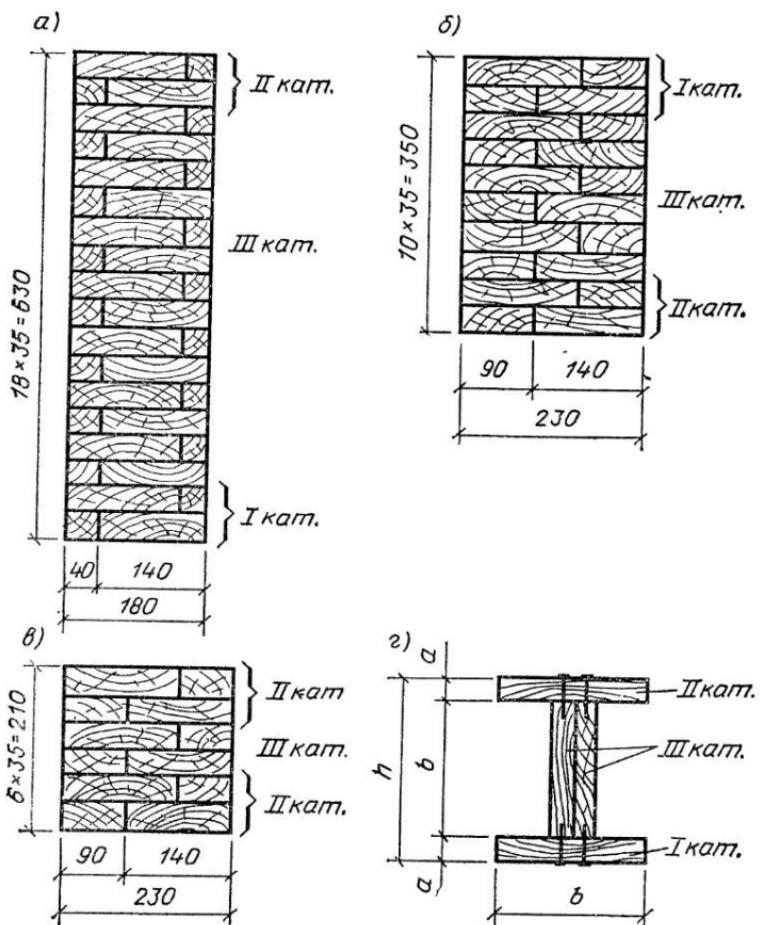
Послойная укладка пиломатериалов в клеенных конструкциях и их категории
